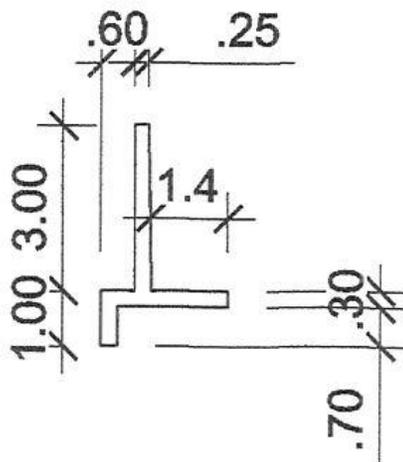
Detalle de la obras de protección, vista en corte transversal.
